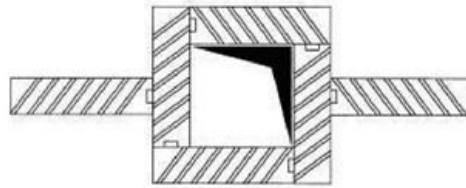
Pilier en blocs de plâtre sur toute la hauteur de la paroi
